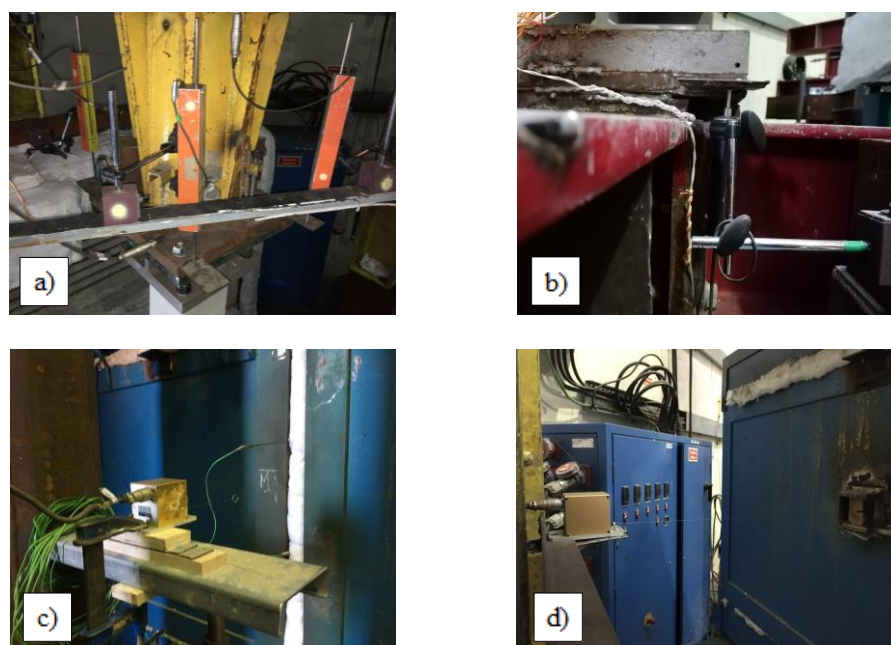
Imagens de pormenor: a) LVDT's verticais superiores (8-10); b) LVDT's verticais inferiores (1-4); c) Transdutor de fio horizontal (5); d) Transdutor de fio horizontal (6).
